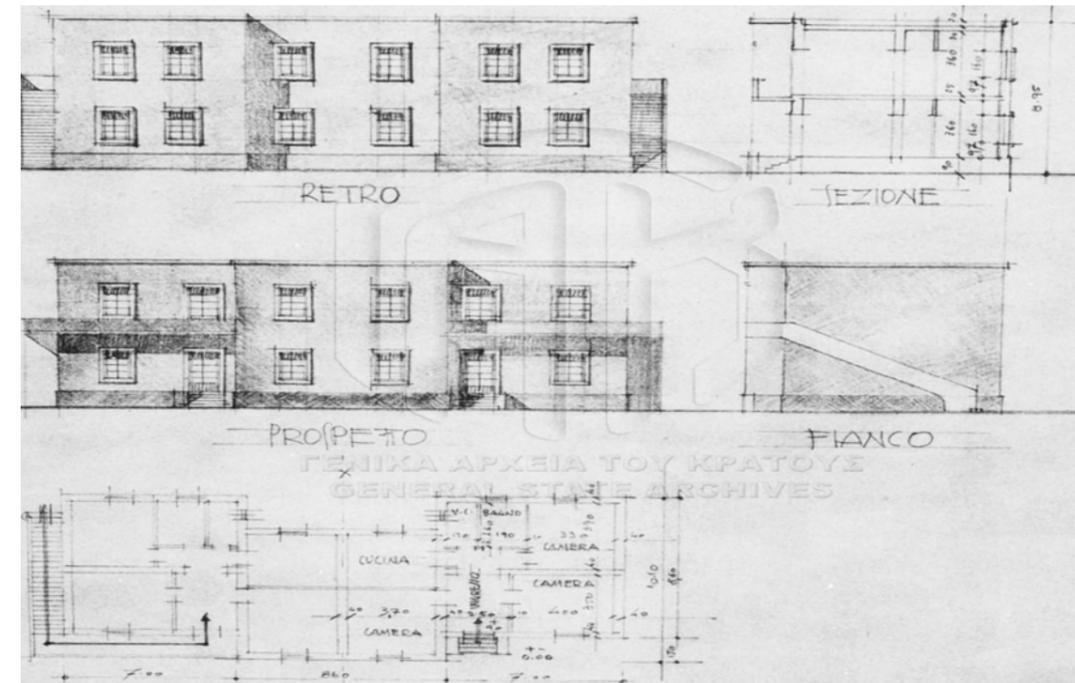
casa operai 2, piante prospetti e sezione, sc. 1:100
